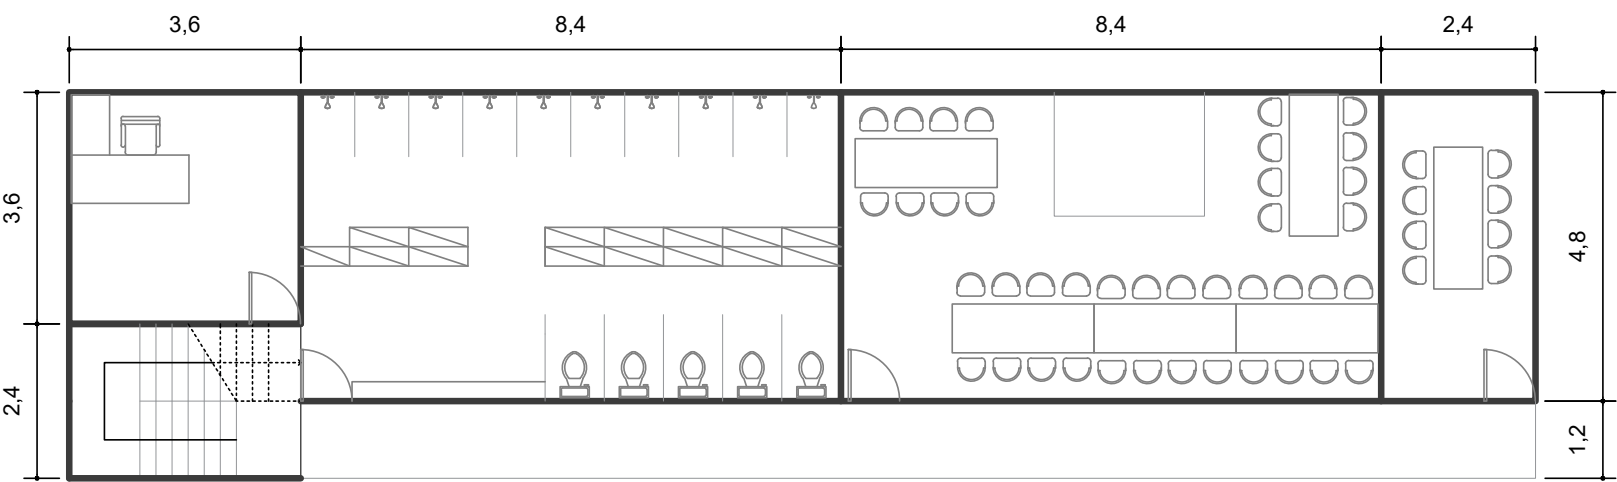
Planta do pavimento térreo da construção temporária da obra da R. Yasbek
